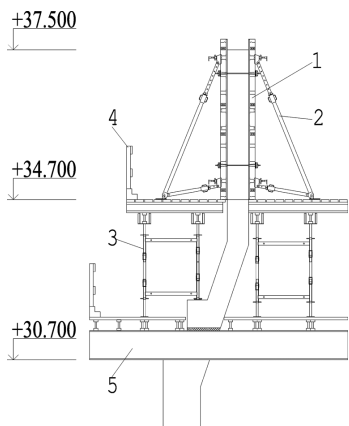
Схема устройства разгружающей площадки на отм. +30.700:
